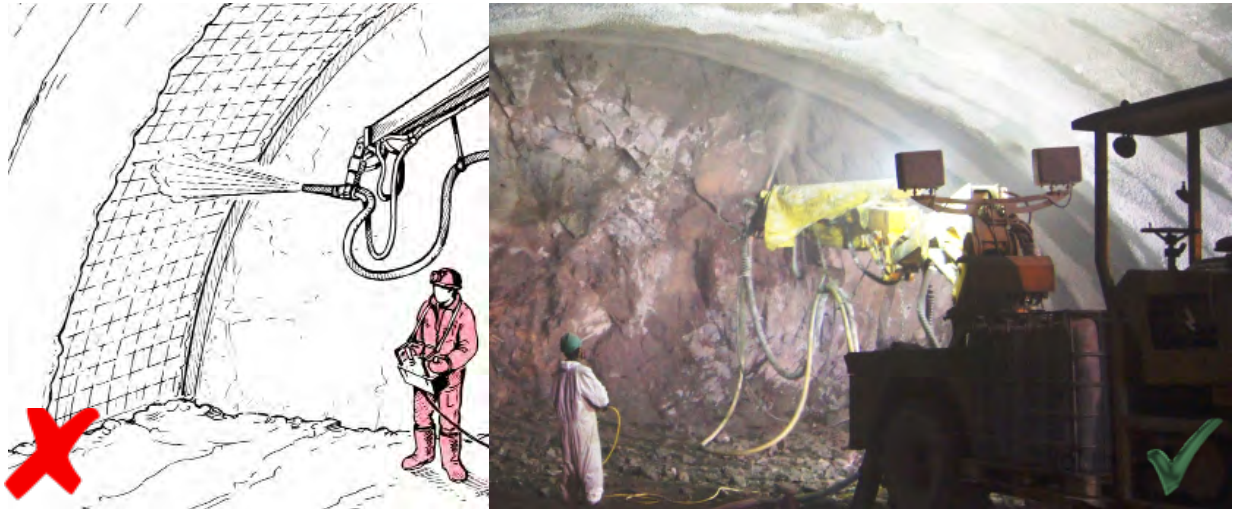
Lanzado de concreto mediante robot lanzador en el frente de excavación del túnel.
